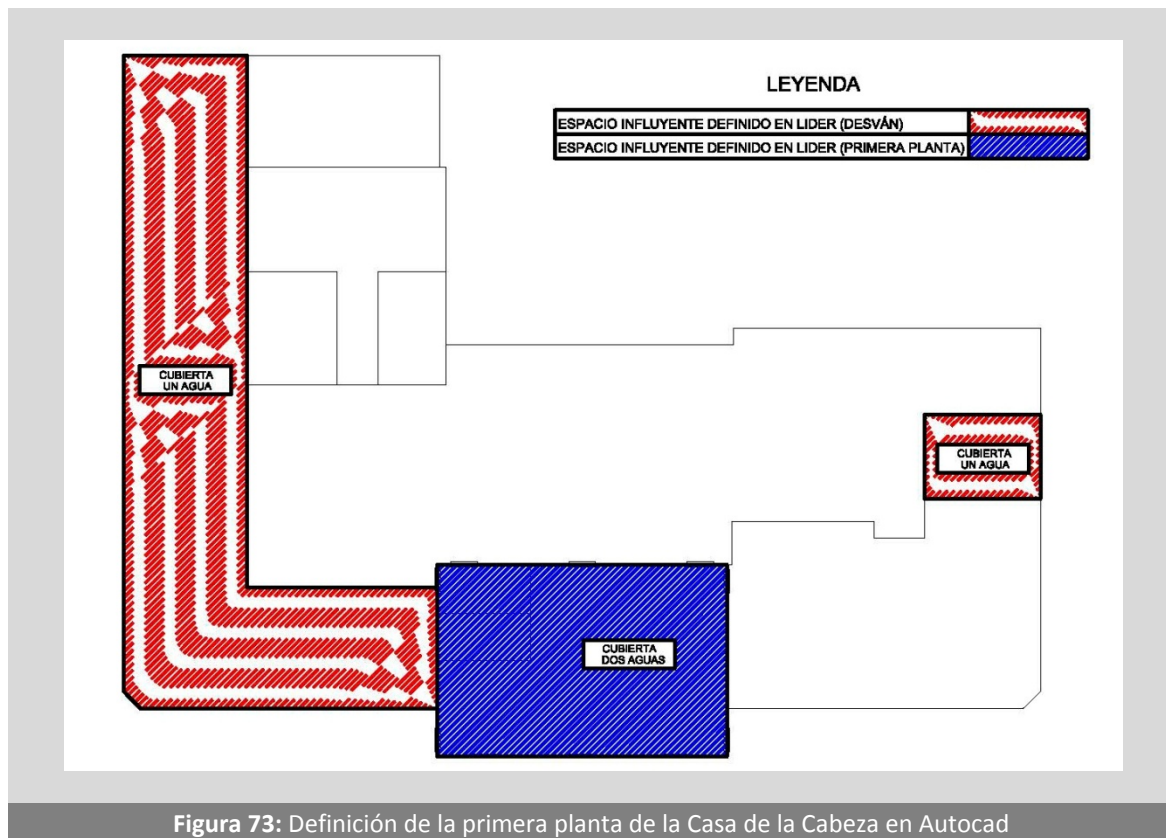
Definición de la primera planta de la Casa de la Cabeza en Autocad
